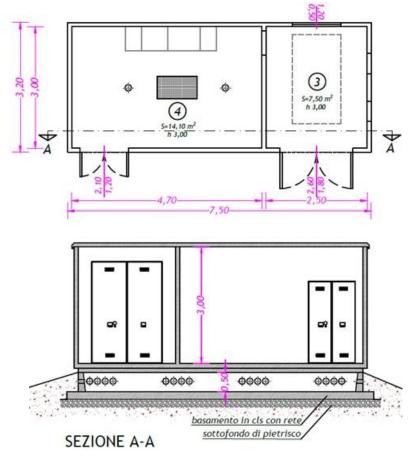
Pianta e profilo delle cabine MT/BT n.1 e n.2
